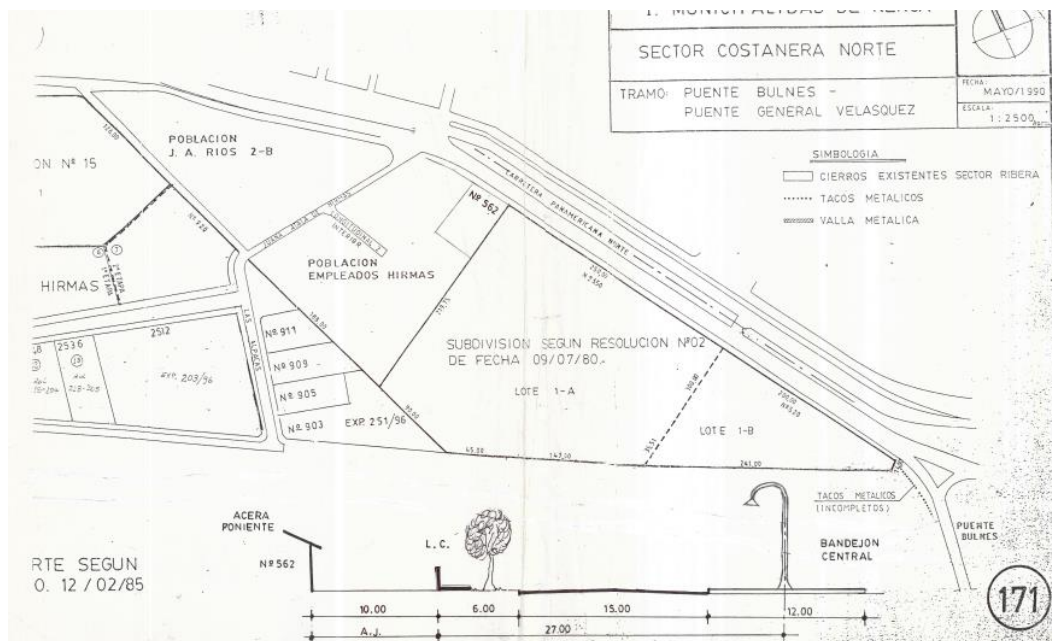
Plan subdivisión terrenos Textil Hirmas, Arquitecto Jorge Altamira Muñoz (1990)
